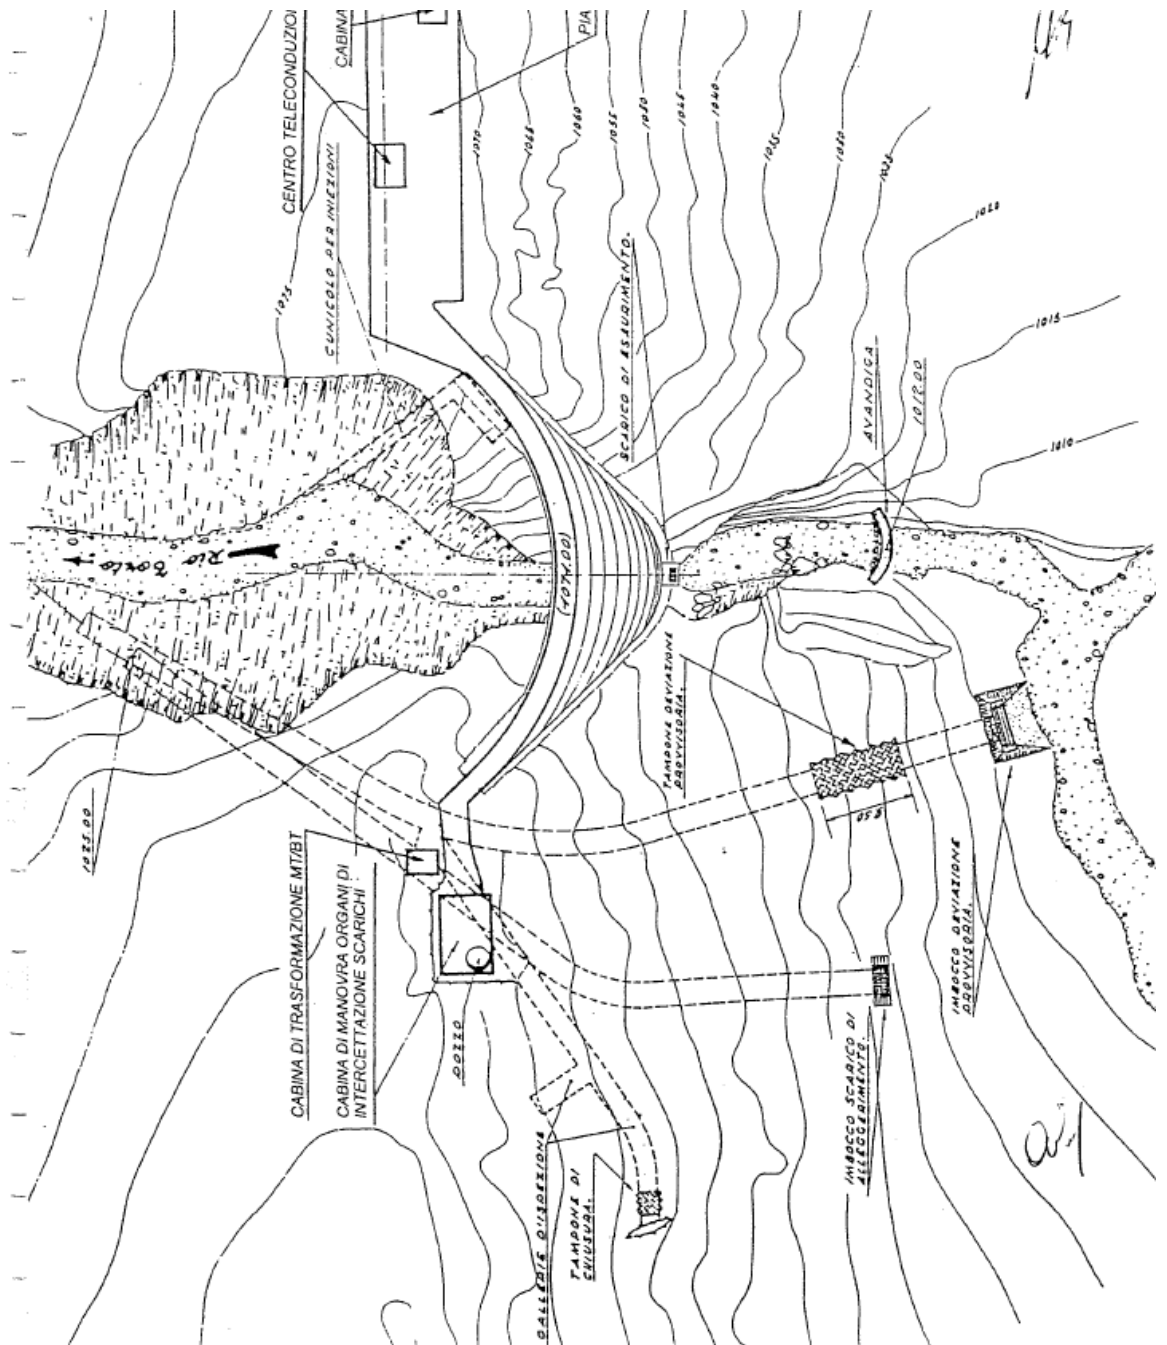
Invaso di Montagna Spaccata. Diga Principale. Planimetria
